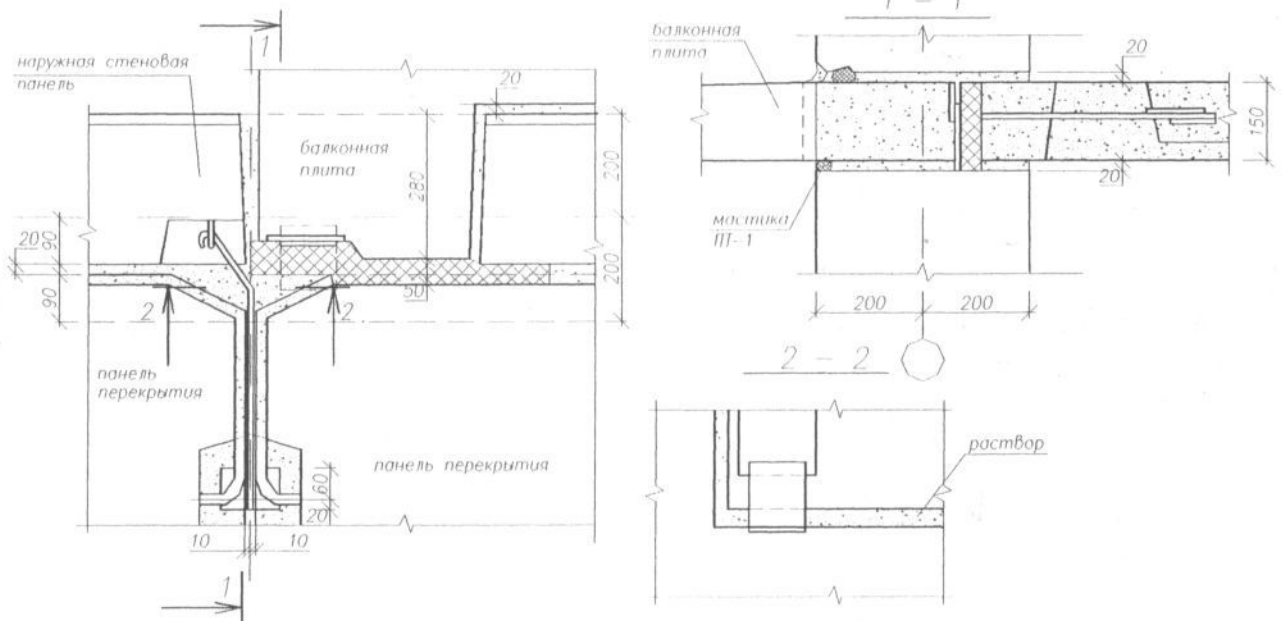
Стык наружных стеновых панелей с плитами перекрытий и лоджий
